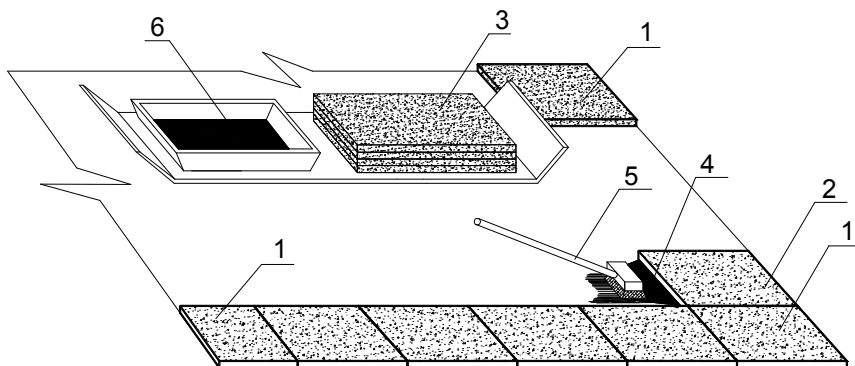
Технологическая схема укладки плитного утеплителя на мастике:
